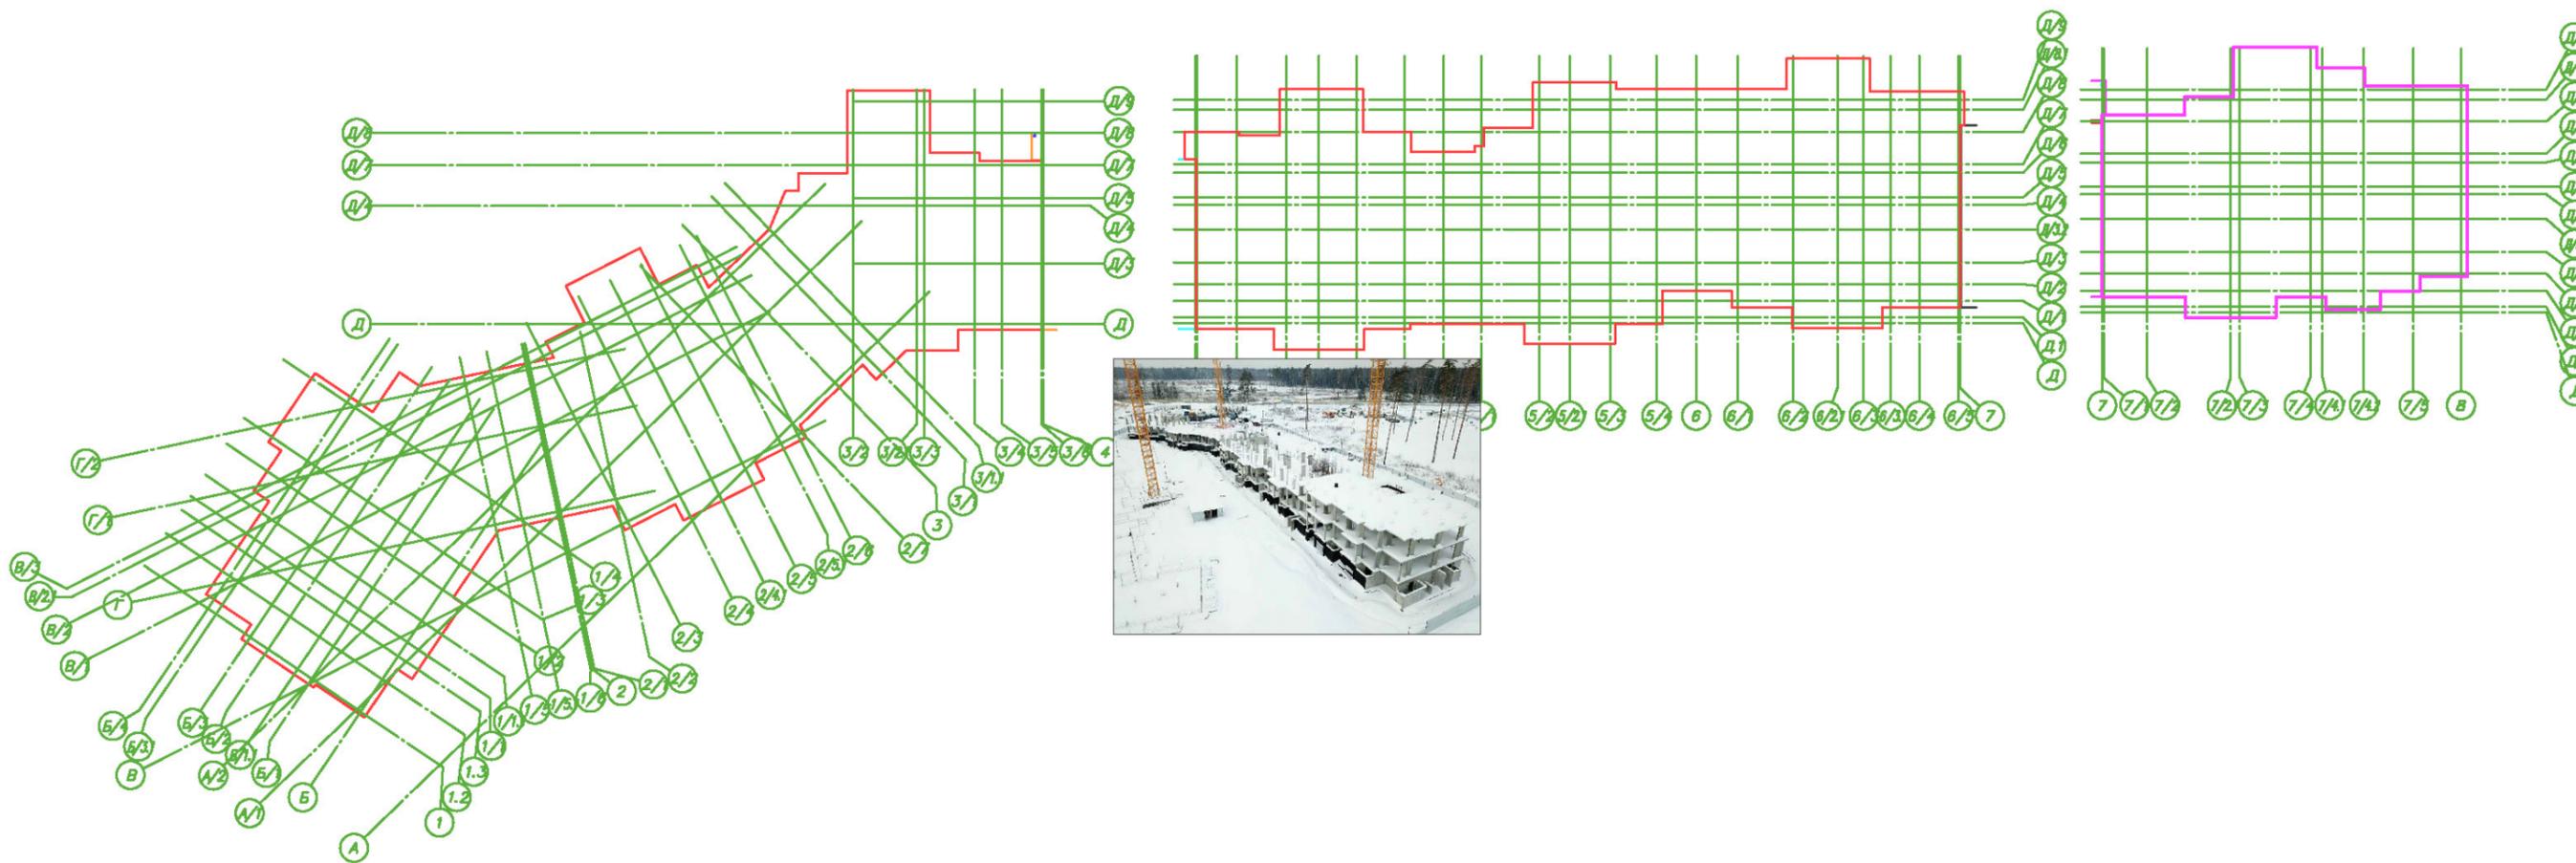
План фактически смонтированных конструкций 3-го этажа секции № 7
